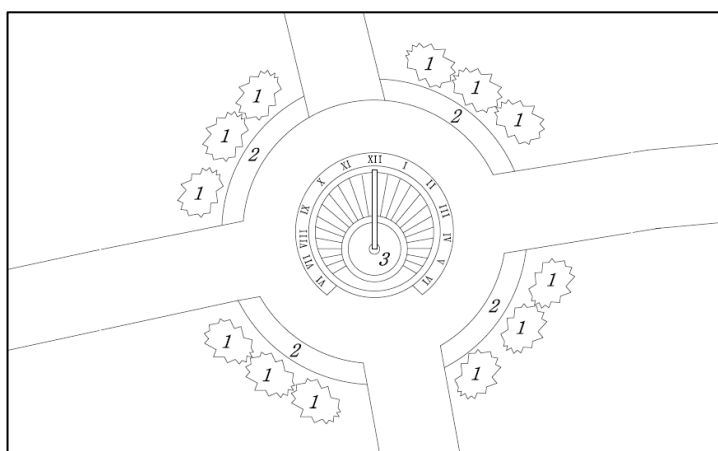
Фрагмент генплана 4, схема посадки растений для «солнечных часов»
